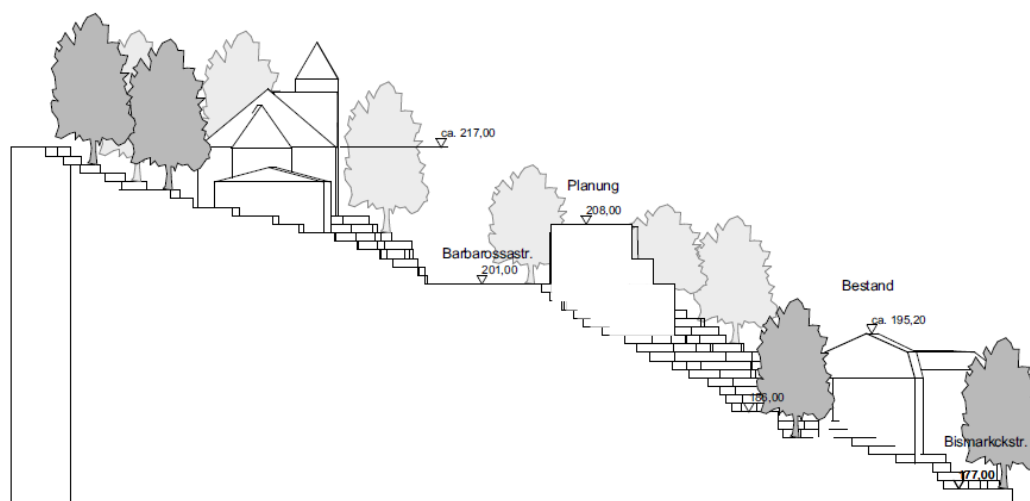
Geländeschnitt mit Grobplanung der Bebauung
